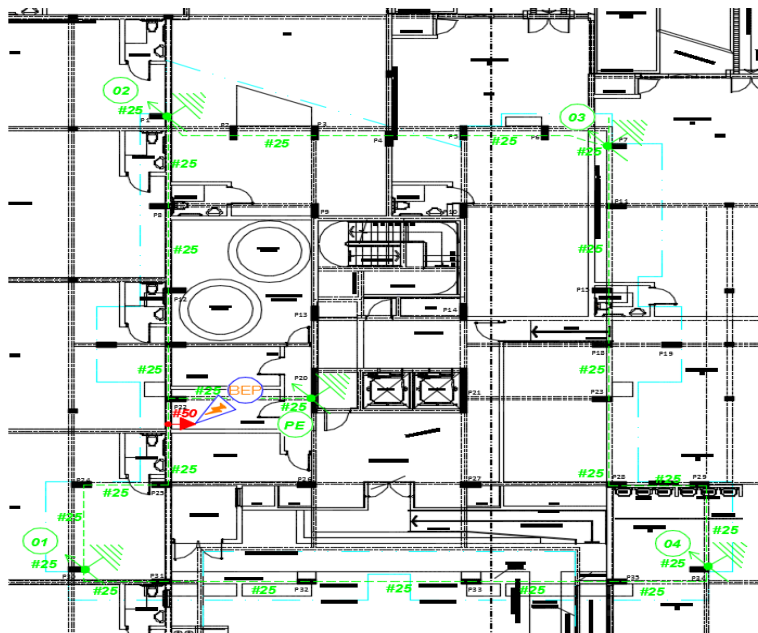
Croqui da Planta DE-9548-001 com ponto de medição de continuidade elétrica – Pavimento Térreo
